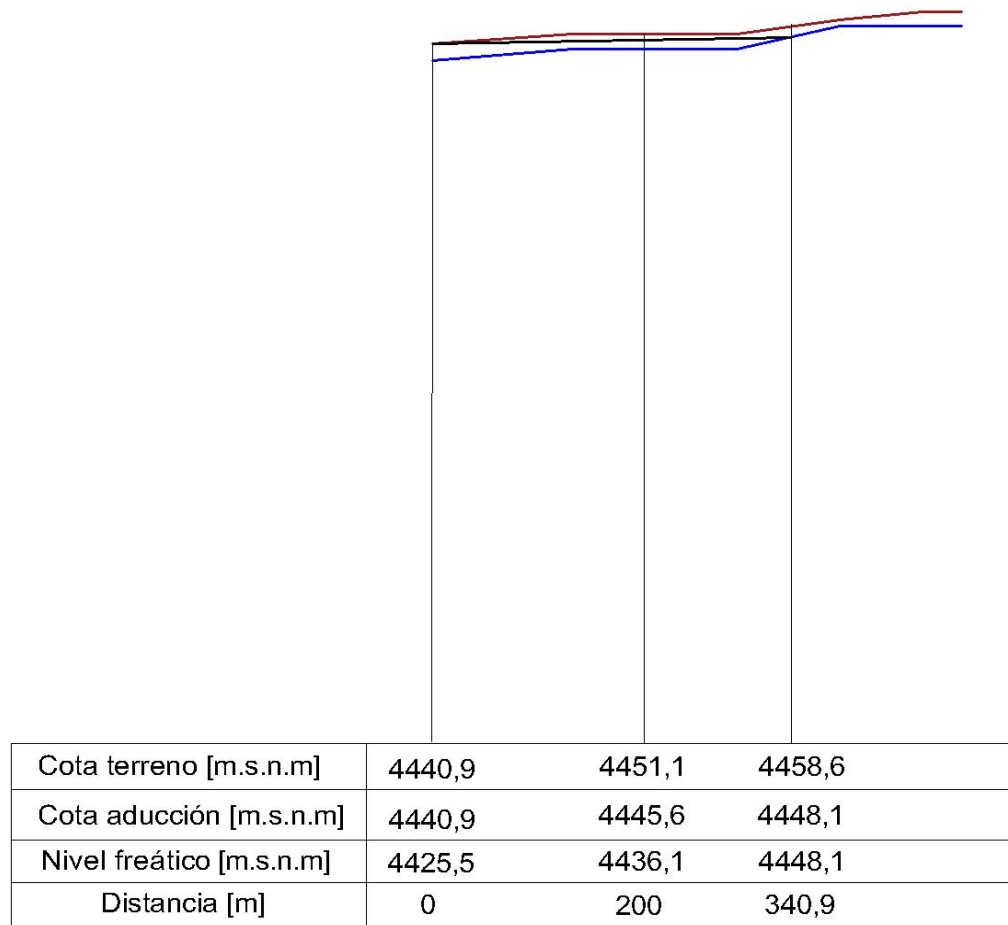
Perfil longitudinal de aducción en Quebrada 4 - 2.
